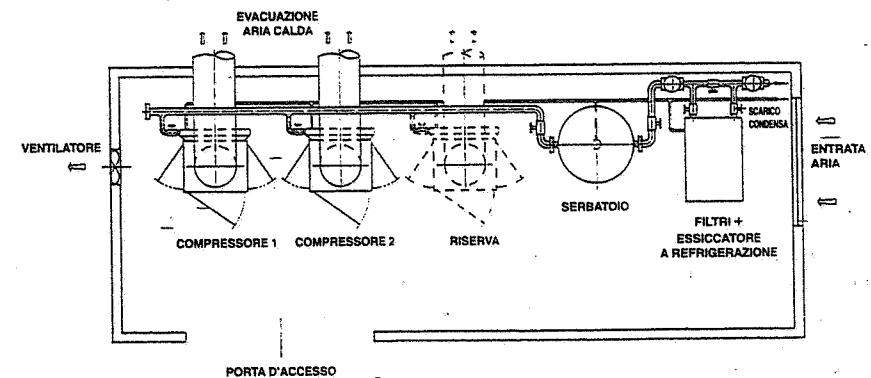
Sistemazione planimetrica di una sala compressori.
